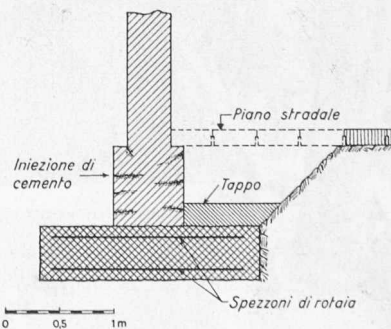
Injizierter Betonbalken zur Unterfangung eines durch Erosion des ursprünglichen Fundamentsockels gefährdeten Gebäudes, Masstab 1:70. Der Zementmörtel wird mit einem der neuen Bodenpressung entsprechenden Druck injiziert
